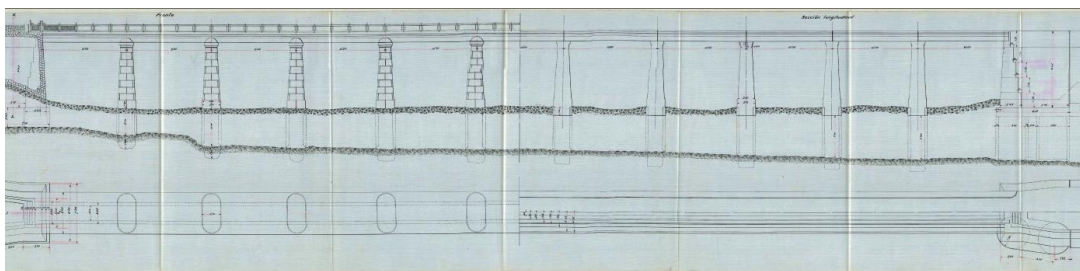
Elevación longitudinal y planta arquitectónica del puente [12]
